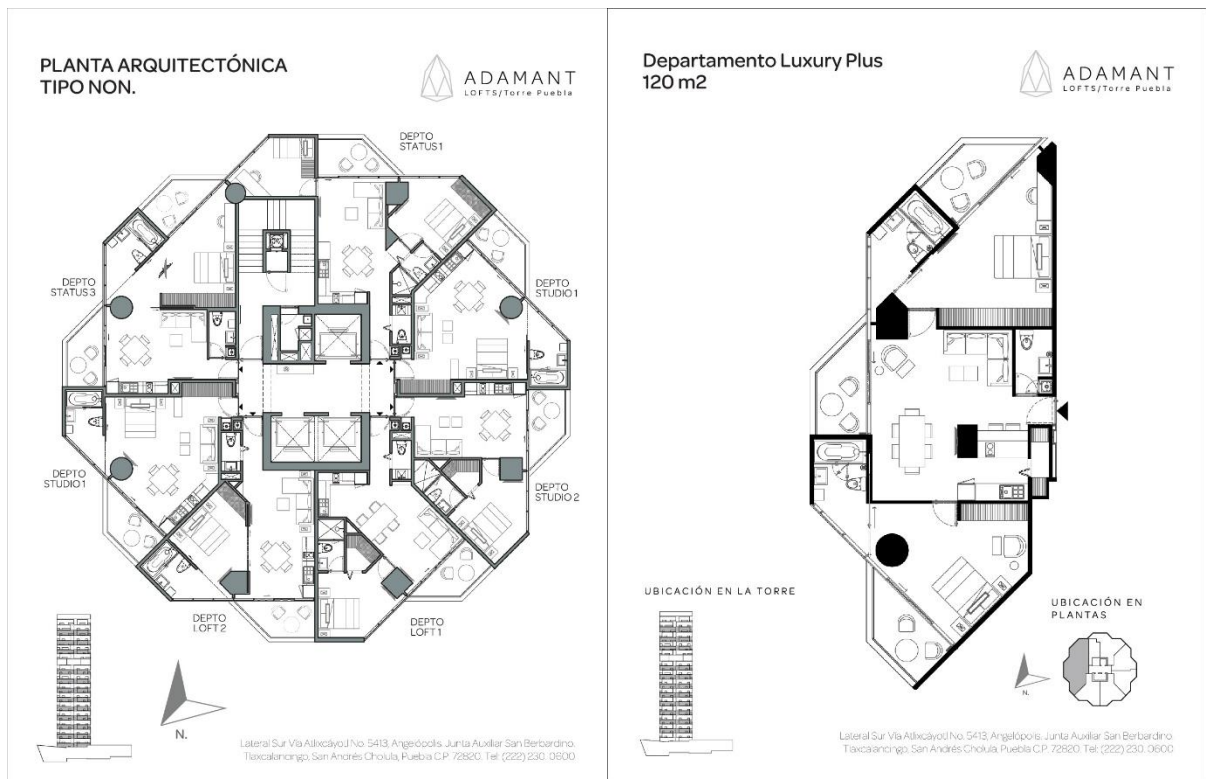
Plantas arquitectónicas de algunos departamentos.
